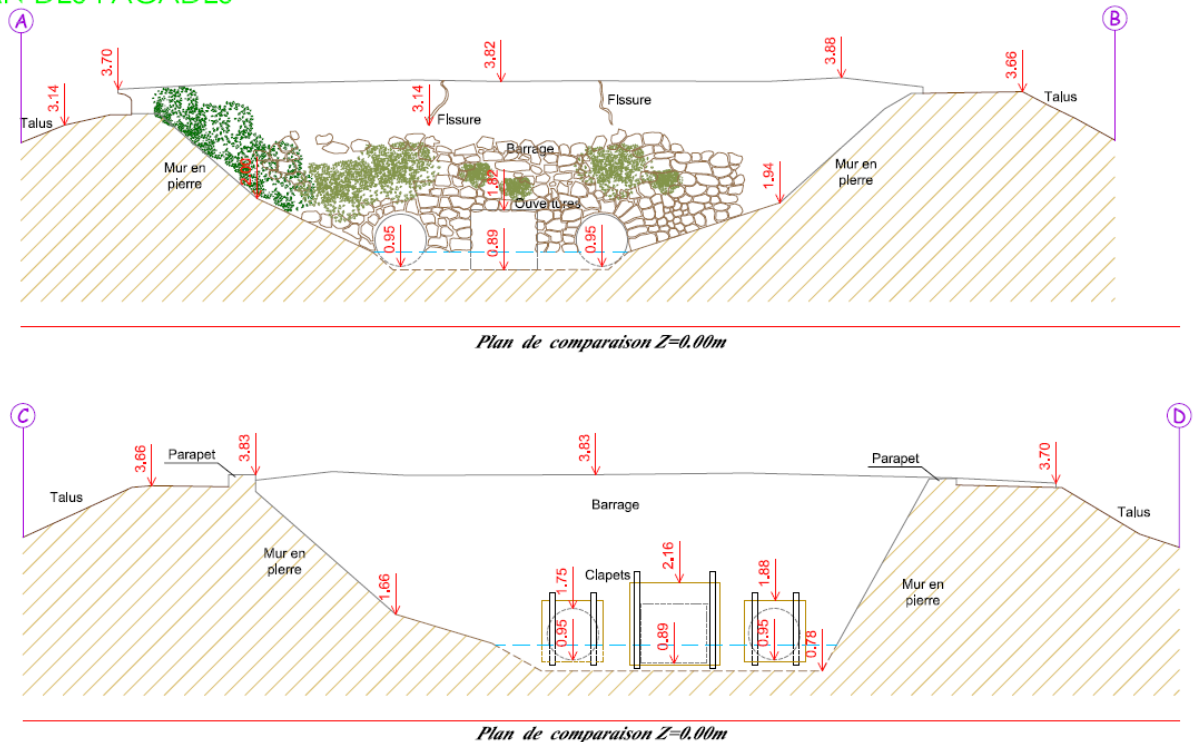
Plans des façades de l'ouvrage de Bérigo (AGE – 2015)
